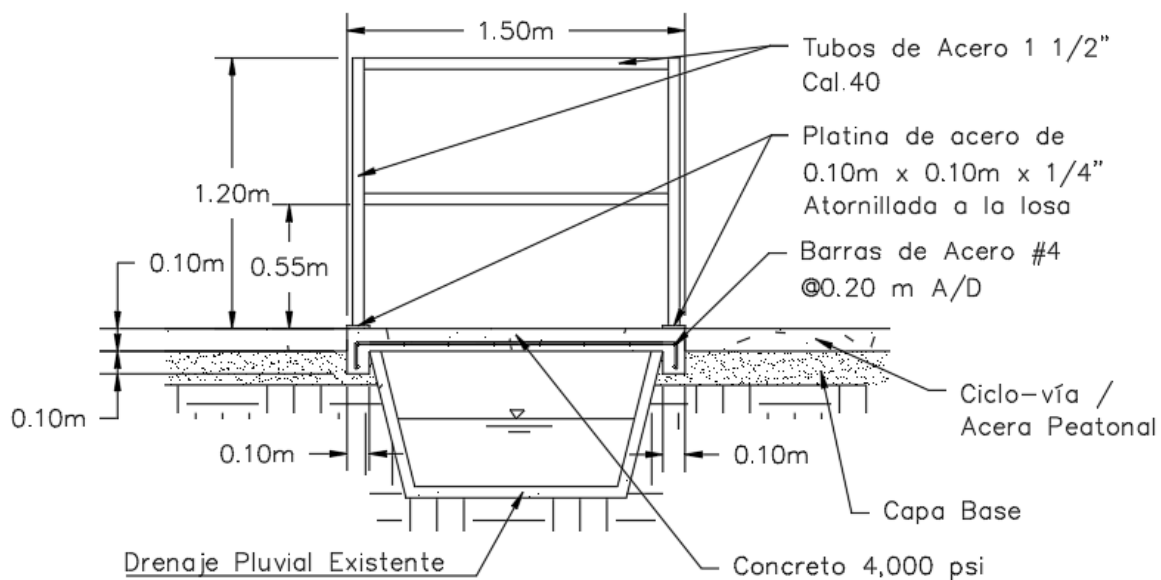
Sección Transversal 1/C de Cajón Pluvial en la estación 0K+003 m.
